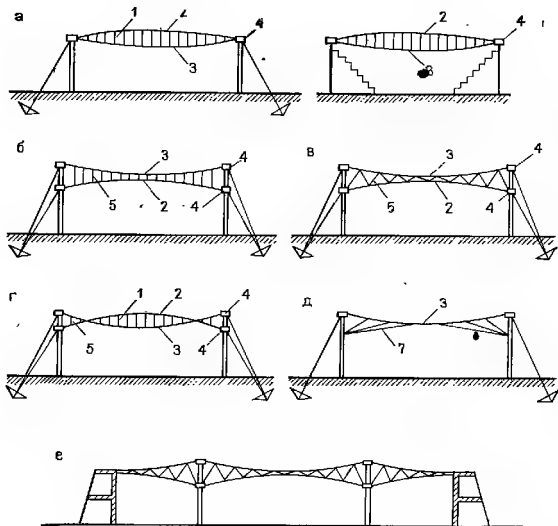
Системы двухъярусных покрытий с параллельными вантами
